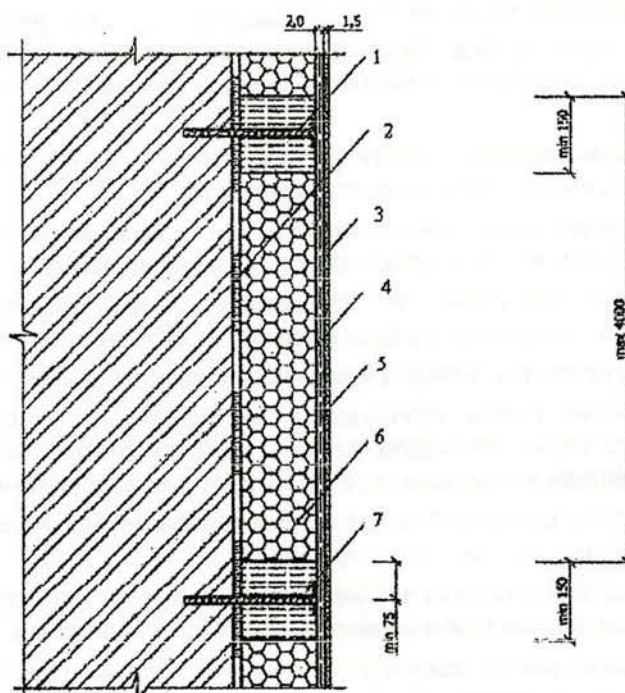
Устройство противопожарных рассечек по высоте здания:
